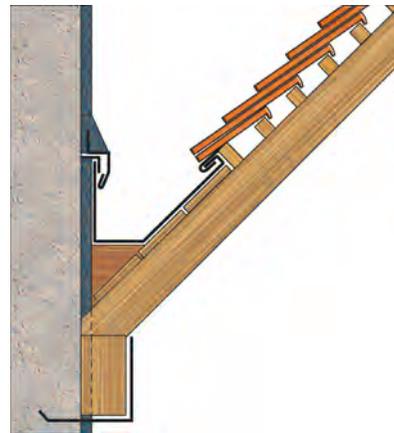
Chéneau avec tuiles plates (de terre cuite ou en béton)
